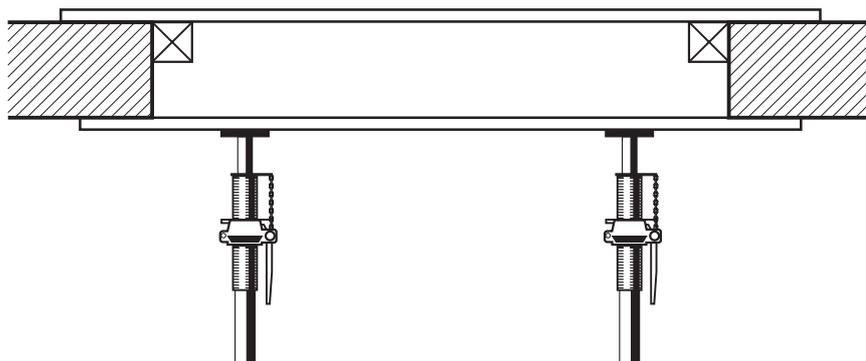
Recouvrement des découpes de sol ou de plafond
